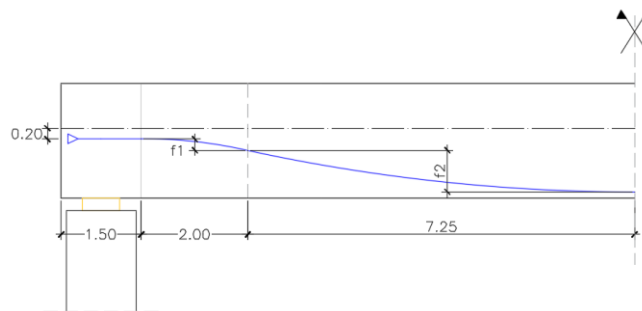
Traçado dos cabos de pré-esforço nas vigas dos alinhamentos A e K.
